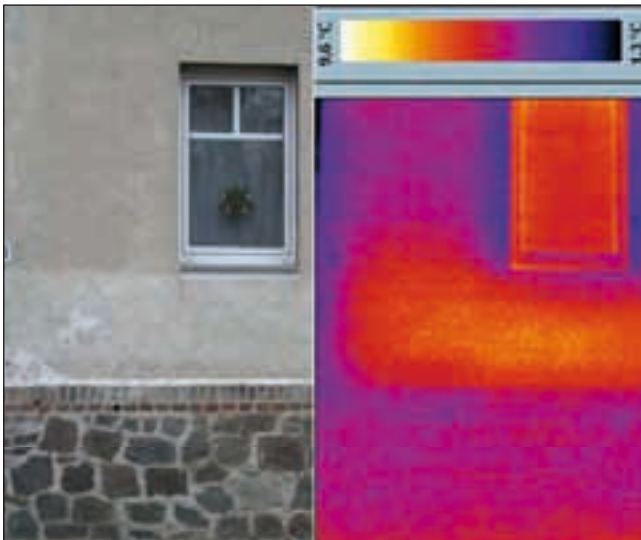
Wandflächenheizung hinter Außenwand ohne Wärmedämmung
